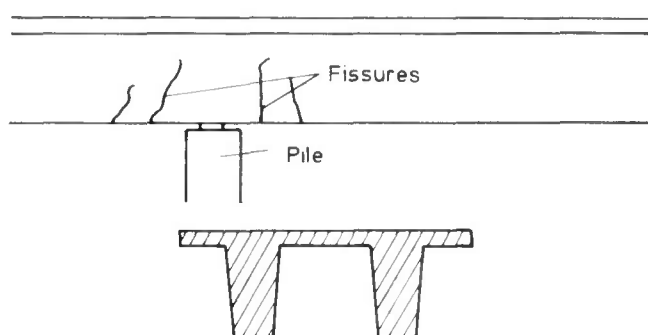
Fissuration-type de ponts à nervures au voisinage d'un appui intermédiaire.
